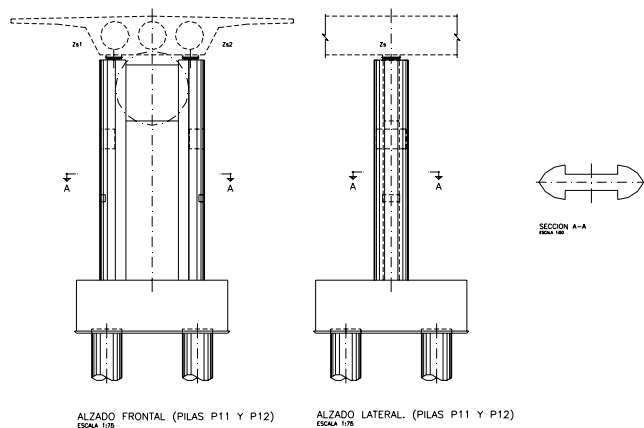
Alzados frontal, lateral y sección transversal de pilas del viaducto nº1
